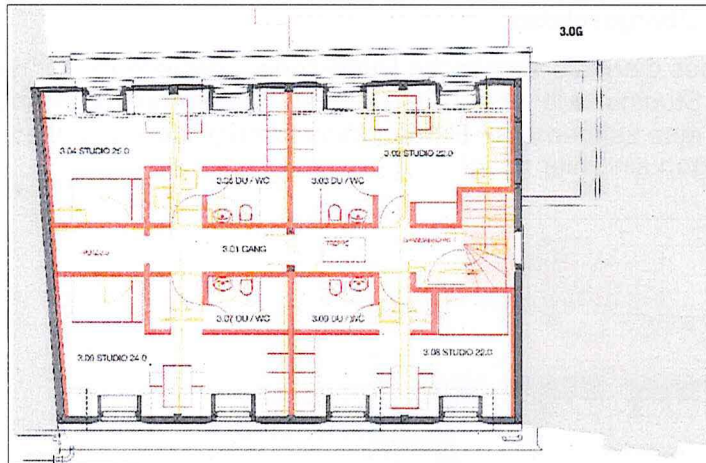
Grundriss Hotelgebäude, 3. Obergeschoss mit vier Studios
